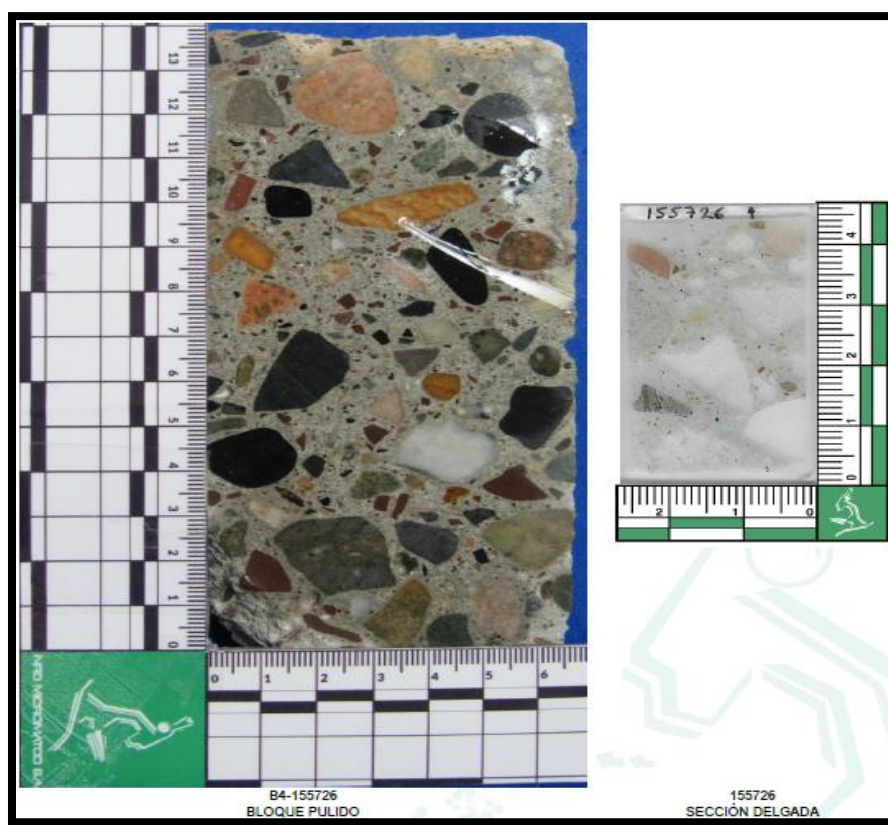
Bloque semipulido y sección delgada de la muestra N1 – Fuente Informe Laboratorio.
